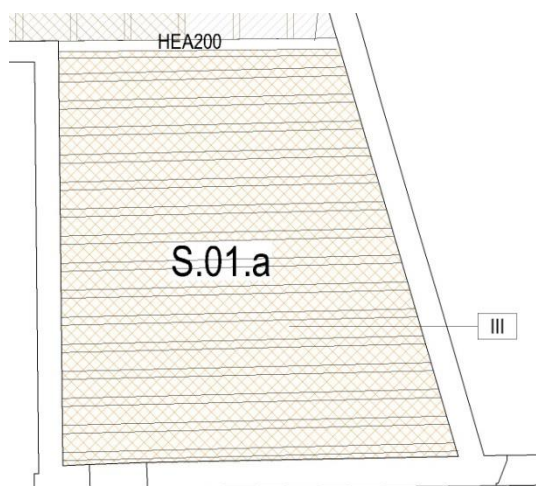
Pianta strutture controsoffitto vano S.01.a
